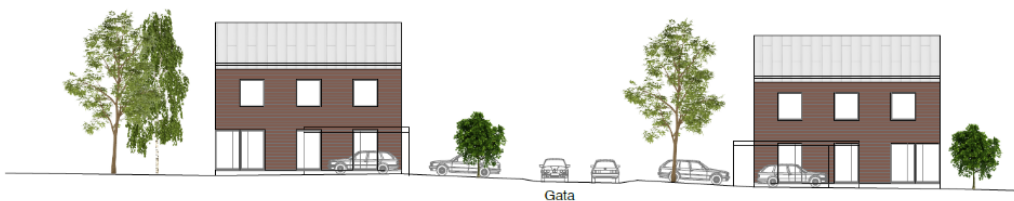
Illustration över den föreslagna bebyggelsen. Sektion A-A (se situationsplan på sidan 13) illustrerar hur bebyggelsen förhåller sig till de befintliga byggnadsvolymer längs Nyvlavägen, och hur den planerade bebyggelsen kan placeras i förhållande till markhöjderna ner mot Nyvlabäcken.
